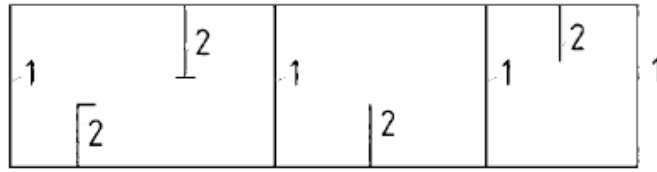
Схема розташування поперечних стін будівлі із різною жорсткістю: 1 – стіни значної жорсткості (діафрагми);
